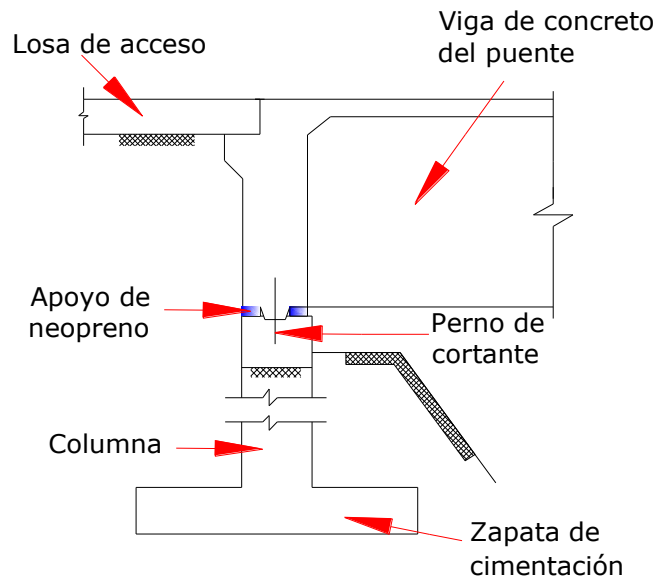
Estribo integral, tipo de neopreno móvil y fijo , sobre columna y zapata de cimentación
